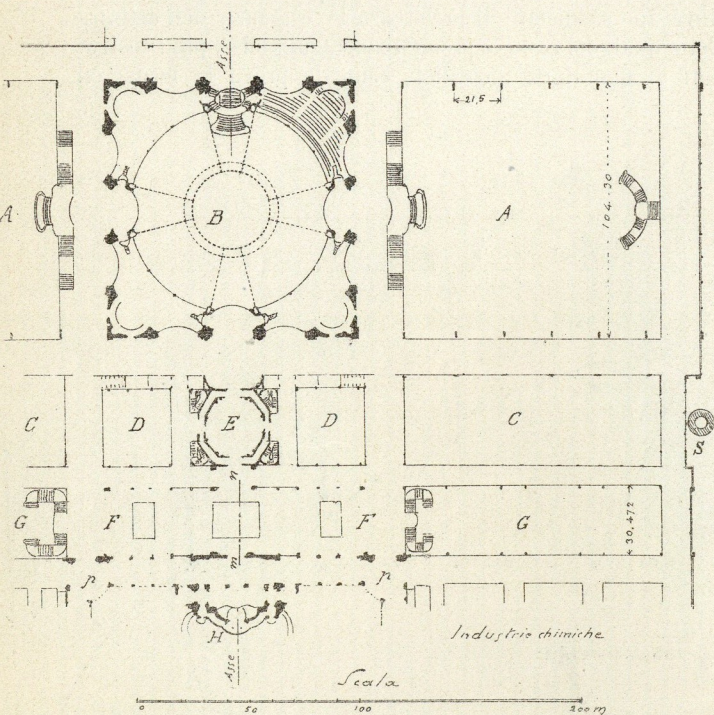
Planimetria degli edifizii in testa al Campo di Marte.
